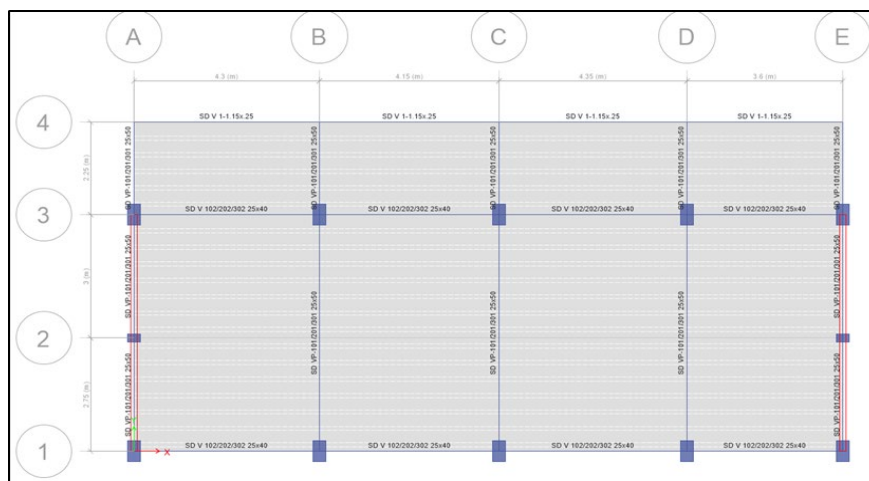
Vista en planta del primer piso del bloque a evaluar.
